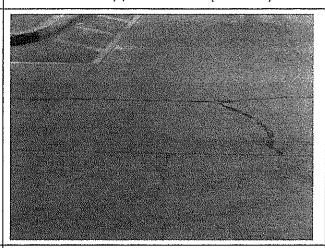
Detaile de fisuras y grietas con sellos deteriorados (foto N°14), cercano a kilómetro 8,9, camino rol G-27. (19-08-2013)
